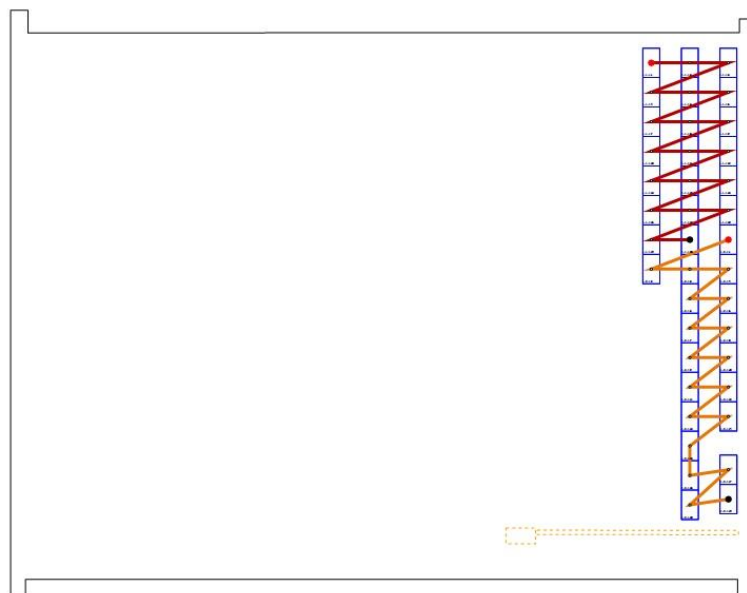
Uproszczony schemat podłączeń odpowiednich stringów do falownika mikroinstalacji PV dla budynku B SP-1
